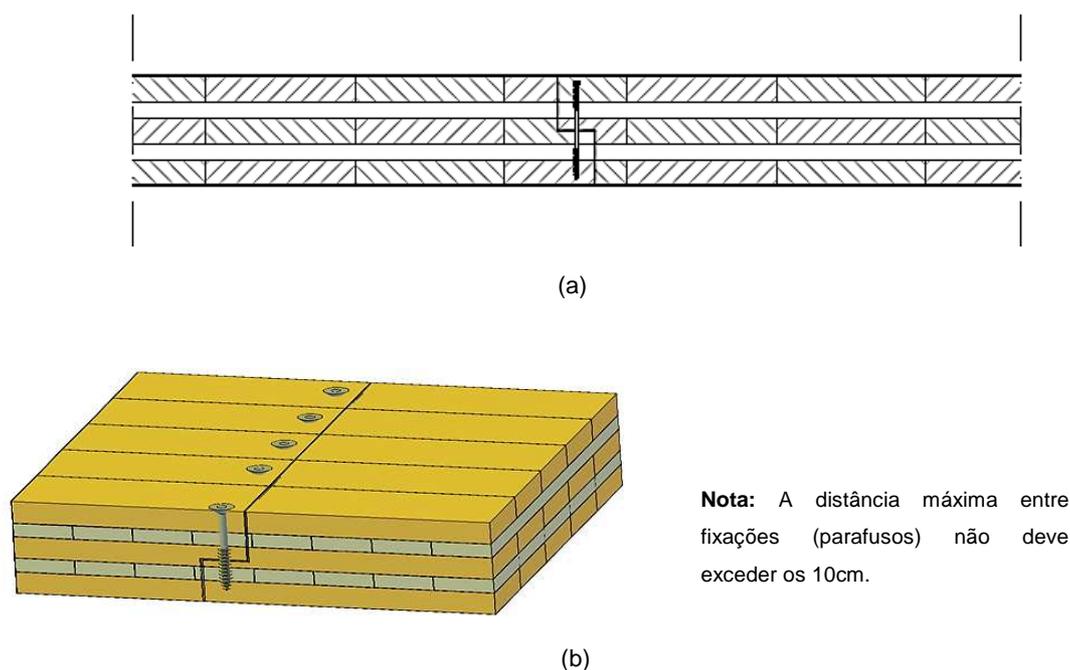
Pormenor de ligação das lajes; (a) corte, (b) perspectiva
